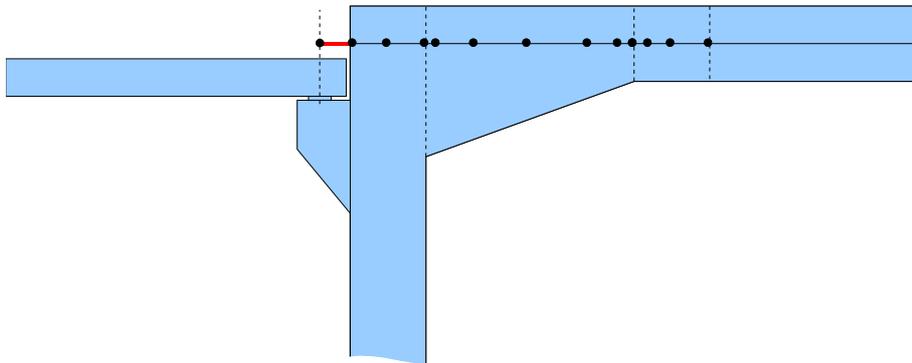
Extension de la traverse par un corbeau (coupe longitudinale)
